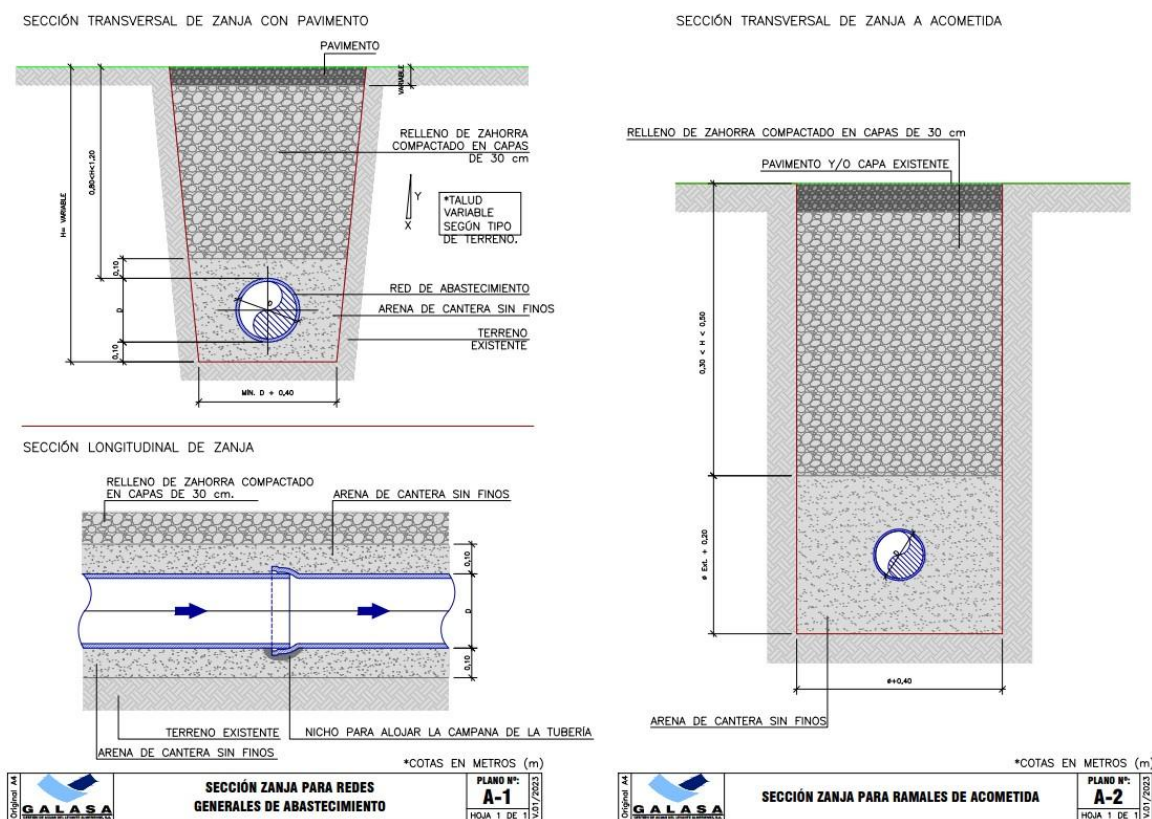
Detalles Constructivo I. Sección de zanja y tubería bajo calzada pavimentada y Detalle Constructivo de zanja de entronque para acometidas. Fuente: Galasa
